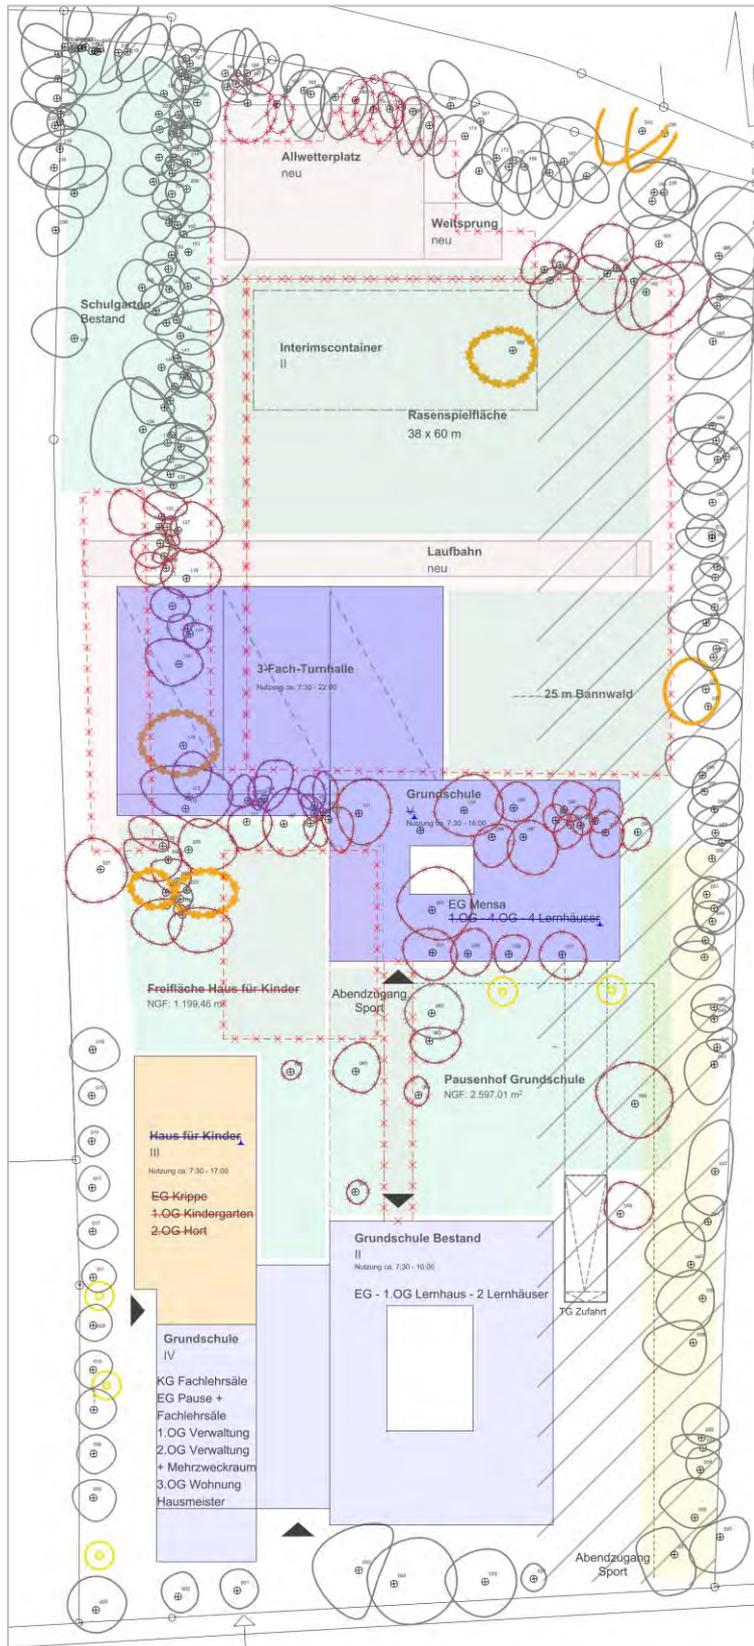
Lageplan Variante 2b [Quelle: LHM; Stand 03.06.2019]
